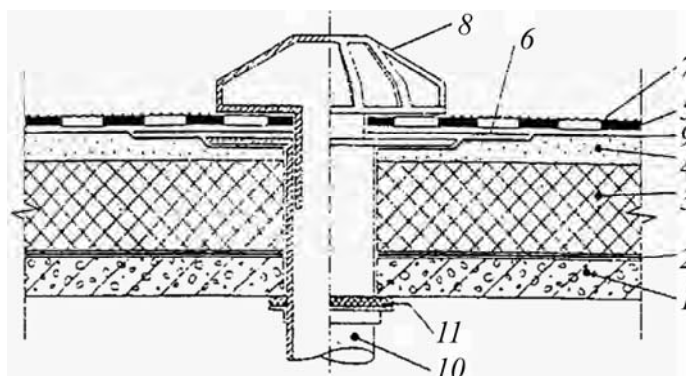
Воронка внутреннего водостока: 1 — железобетонная плита перекрытия; 2 — пароизоляция; 3 — теплоизоляция; 4 — выравнивающая стяжка; 5 — основной кровельный ковер; 6 — дополнительный слой кровельного ковра; 7 — крупнозернистая посыпка верхнего слоя материала; 8 — колпак водоприемной воронки; 9 — грунтовка; 10 — водоприемная чаша; 11 — уплотнитель
